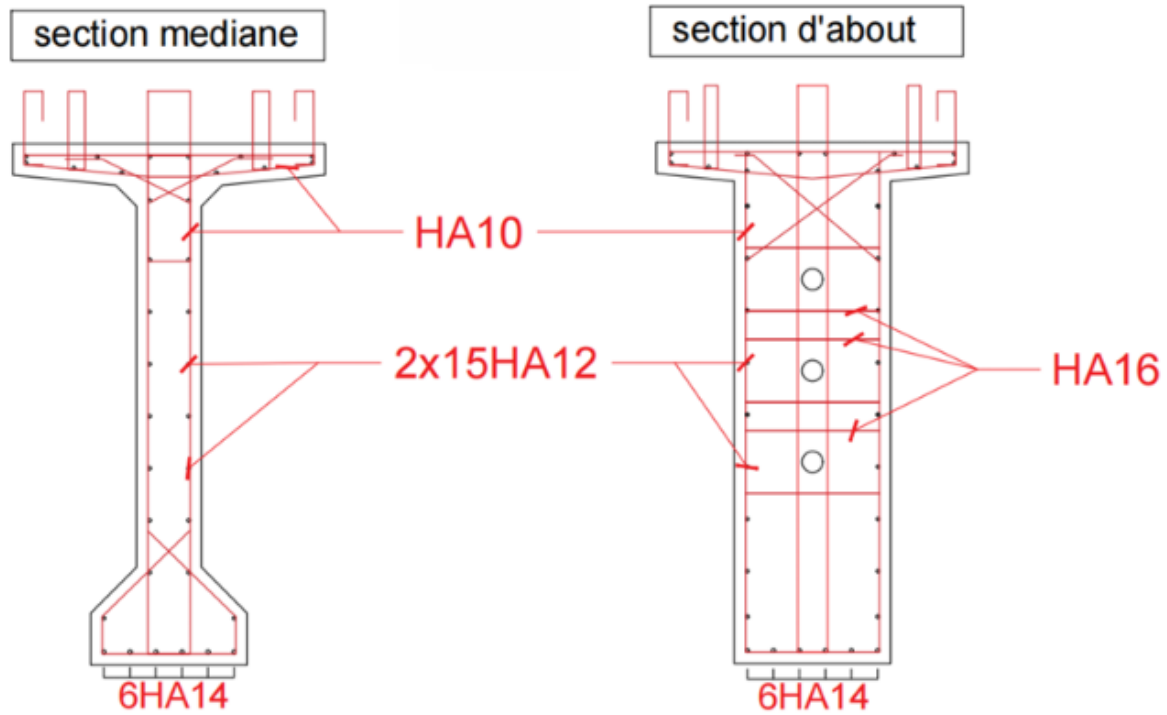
ferrailage de la poutre en section d'about et à mi travée.
